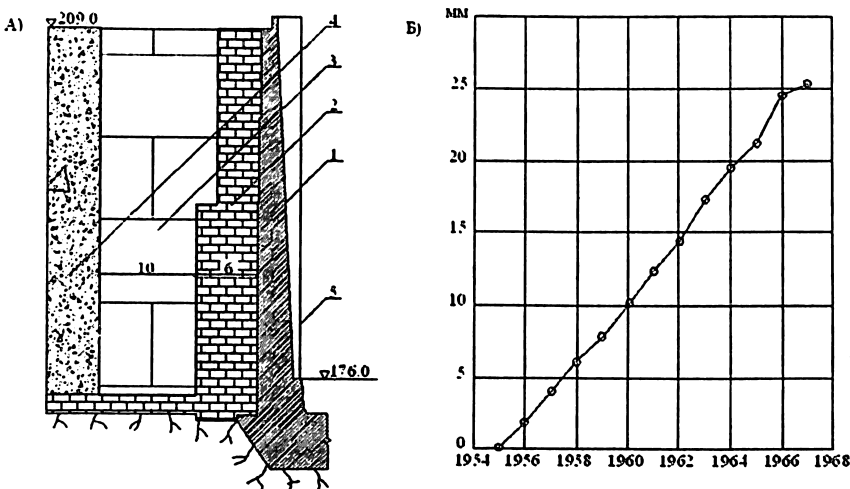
Перемещение сопрягающего устоя водосброса Широковской ГЭС в сторону водобоя А) схема сопряжения плотины с водосбросом 1 – стена сопрягающего устоя; 2 – сухая кладка камня, 3 – кладка камня с подбором, 4 – каменная наброска, 5 – нить отвеса, Б) показания отвеса
